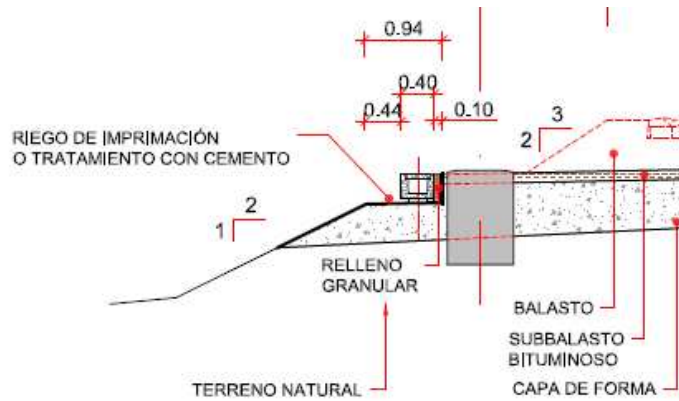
Detalle de canaleta elevada y enrasada (Fuente: (Fuente: elaboración propia).
